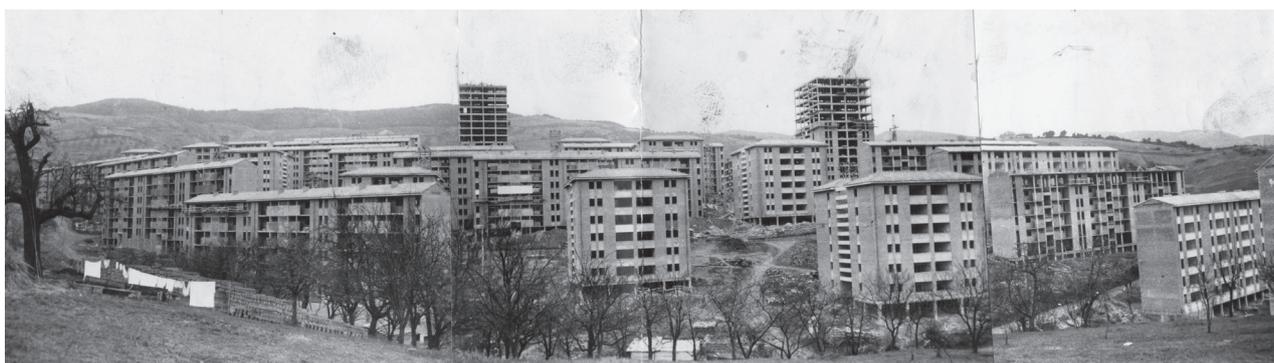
Construcción del Polígono de Ocharcoaga, donde se aprecia el esqueleto de estructura de hormigón.
